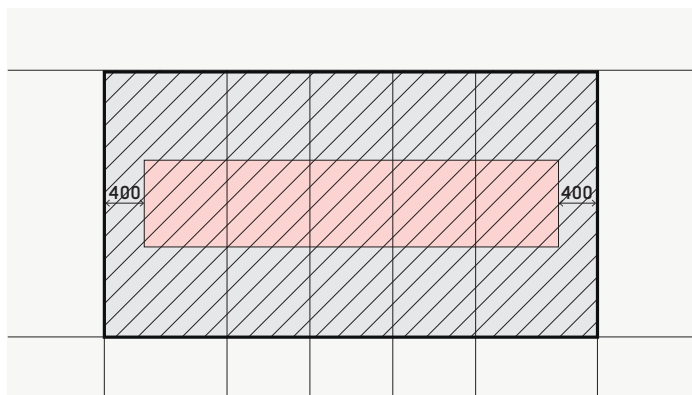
przedstawiają sytuacje, w których „projekt zagospodarowania działki lub terenu” (teren oznaczony skośnym szrafem) obejmuje wydzielony fragment nieruchomości stanowiącej własność inwestora (rysunki pokazują wersję z planem miejscowym oraz wersję z decyzją o warunkach zabudowy; grubą kreską oznaczono granicę nieruchomości stanowiącej własność inwestora). W takich przypadkach, według niektórych interpretacji, „granice” wydzielonego terenu, na którym planowana jest inwestycja, utożsamiane są z „granice działki budowlanej”, co skutkuje nakazem odsuwania obiektów i urządzeń budowlanych od tak rozumianej granicy, pomimo że przebiega ona wewnątrz nieruchomości inwestora. Bywają też na tę kwestię spojrzenia odwrotne.
